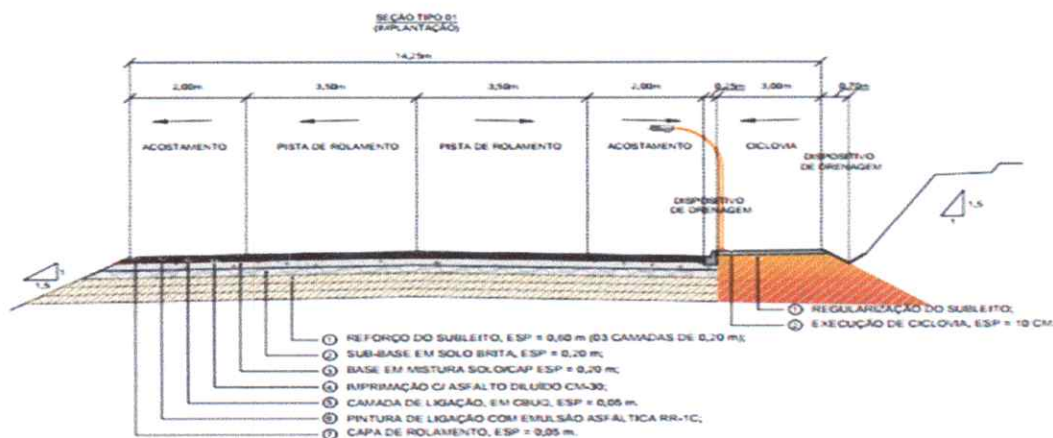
Via 05 – PB-042 (São Miguel do Taipu – Div. Pilar) – Seção Tipo 01
